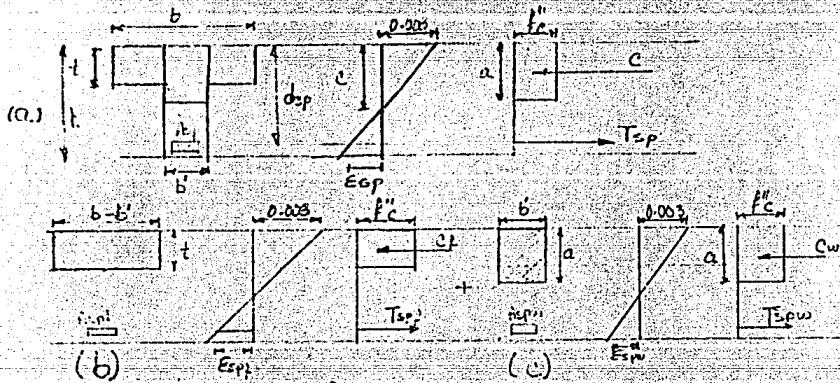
Diagramas de esfuerzos para una viga "T".
